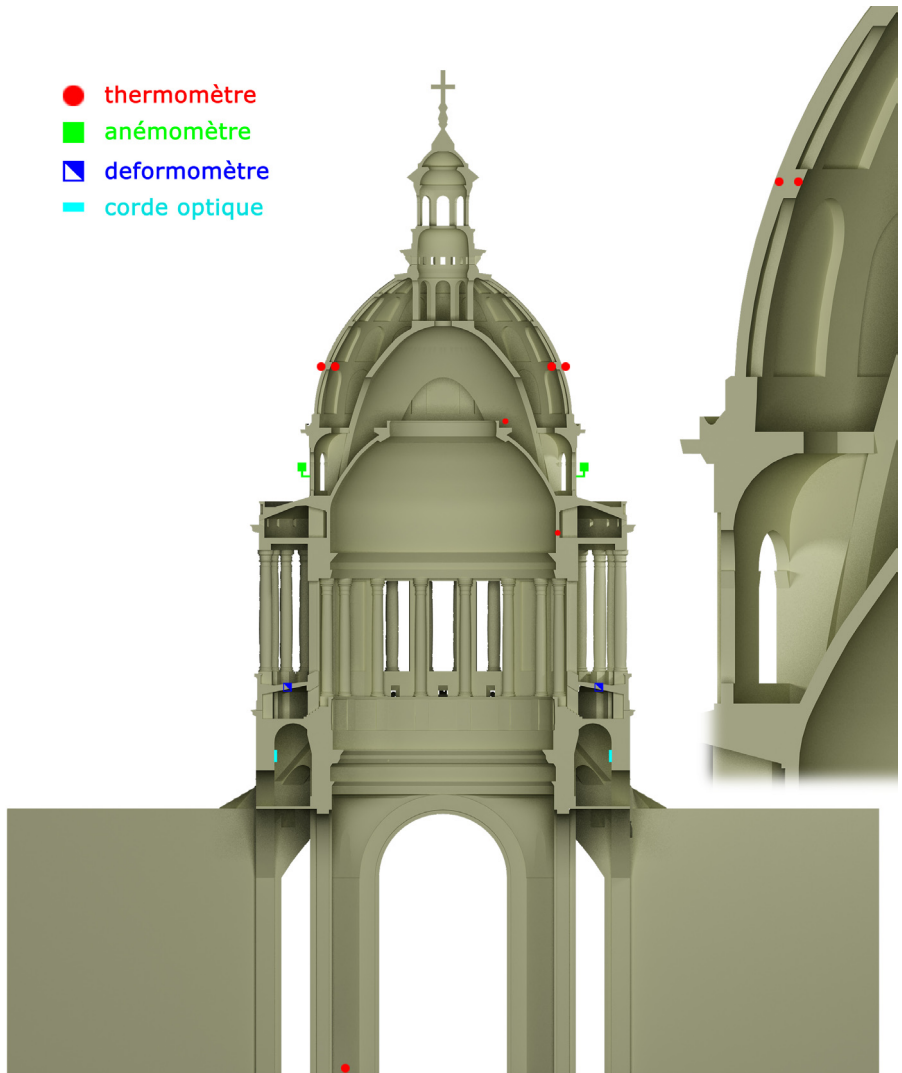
Sezione longitudinale est-ovest. Posizionamento degli strumenti di monitoraggio proposti.
